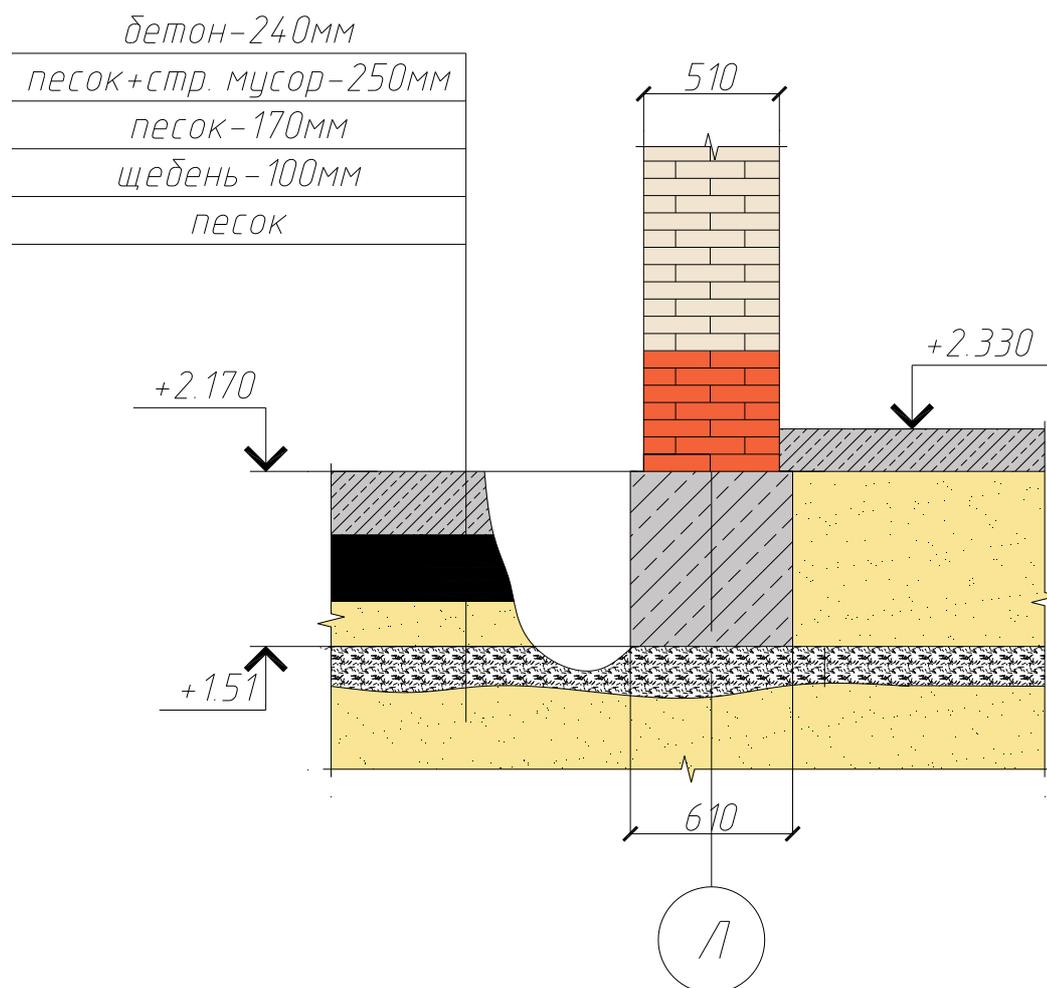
Эскиз поперечного сечения фундамента.
